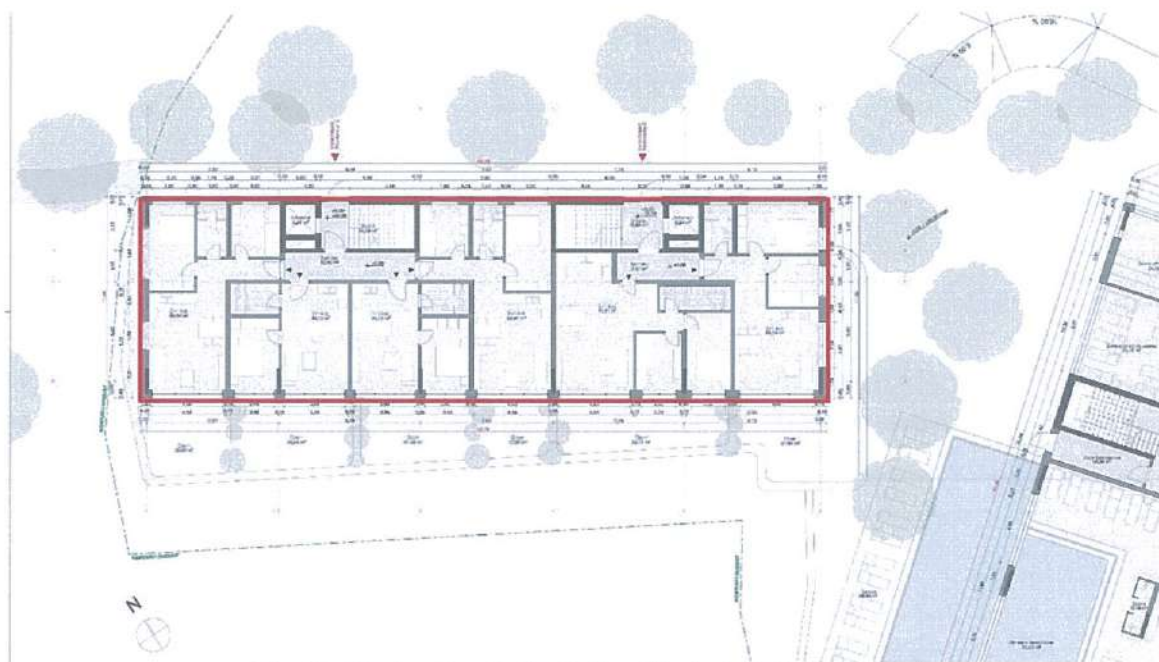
Planimetria e katit përdhe – Sip. kati të përdhe 484.3m²
